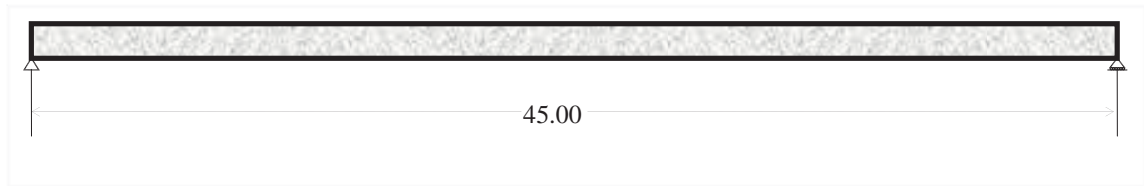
Tipo de apoyo y su longitud entre ellos.
